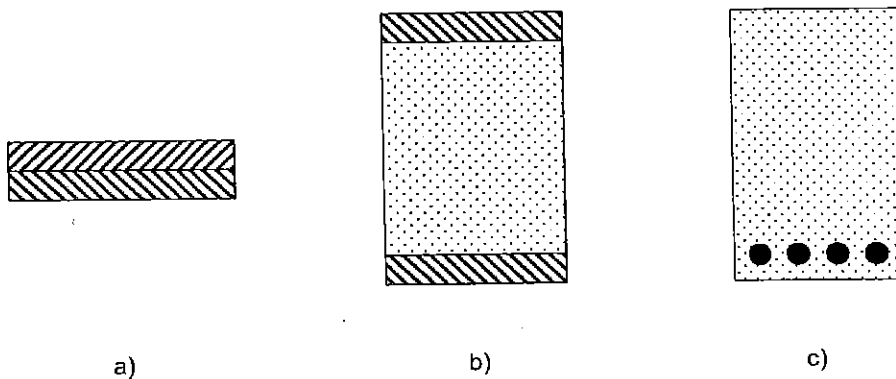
Secciones rectas de vigas de sección heterogénea: a) viga bimetálica; b) viga sándwich; c) viga de hormigón armado
